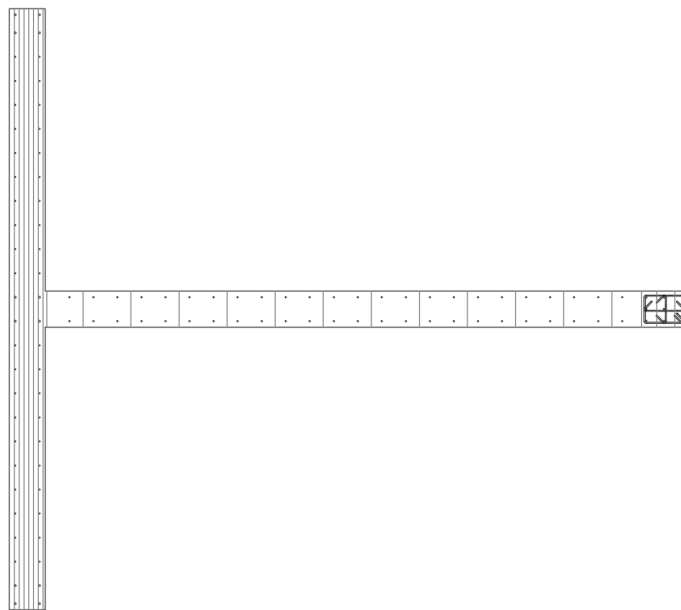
Discretización en fibras de la sección transversal del muro en la estructura base.
